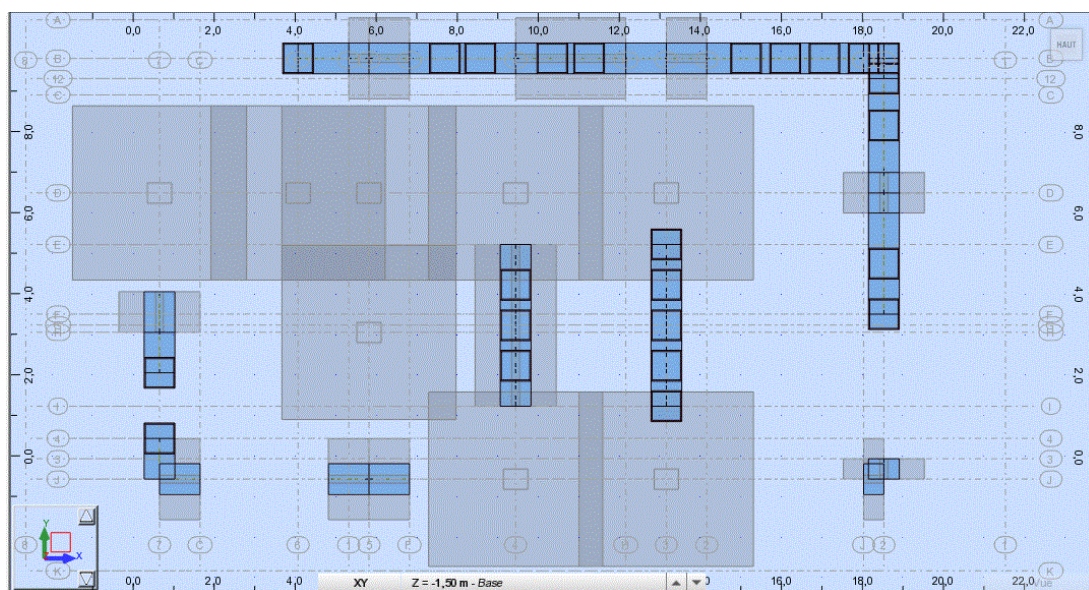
Vue en plan de chevauchement des semelles isolées
